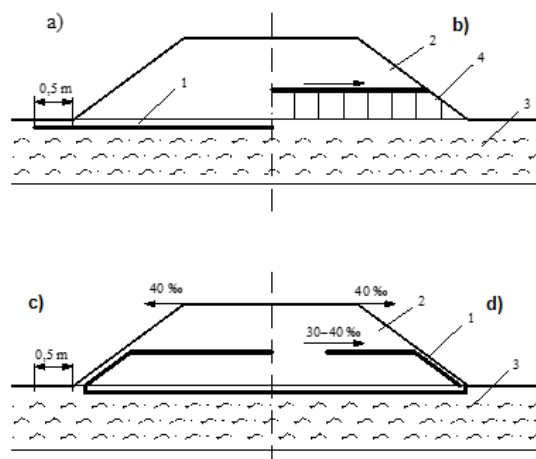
Soluții constructive de bază pentru utilizarea substraturilor din MG de protecție (a, b) și de protecție și armare (c, d) la construcția terasamentelor pe fundații slabe
